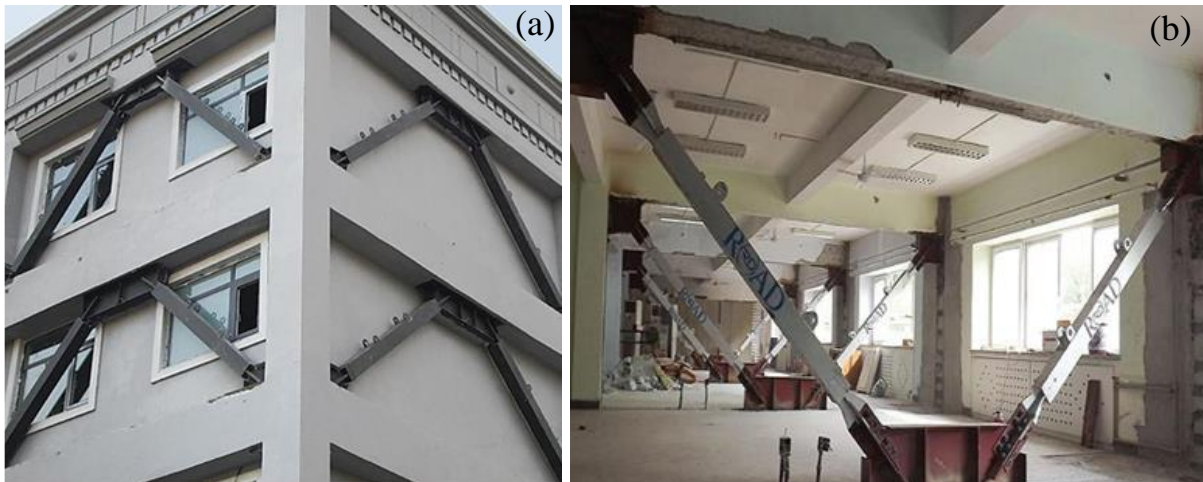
Ejemplos de retrofit de marcos de hormigón armado con BRB: (a) Uso de BRB en escuela [5]; (b) Uso de BRB en hospital [5].
